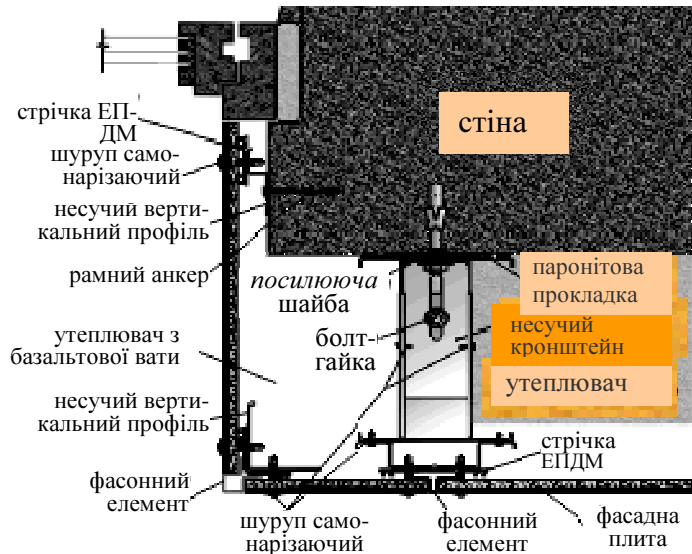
Кріплення фасадної плити на ріг будинку (2-й варіант)
